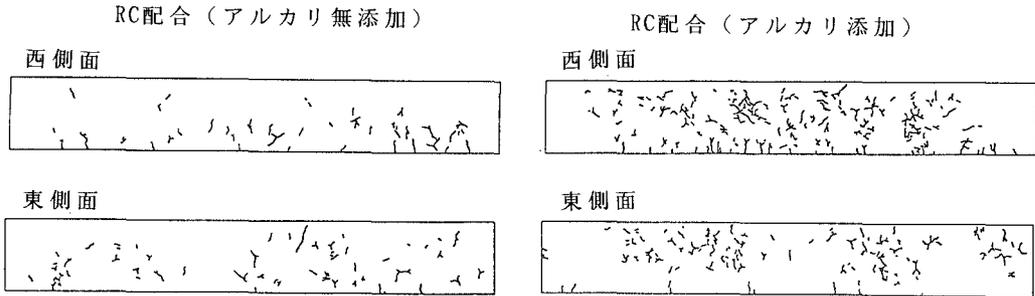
電気防食を実施したRC配合コンクリート供試体（アルカリ無添加および添加）のひびわれ状況
